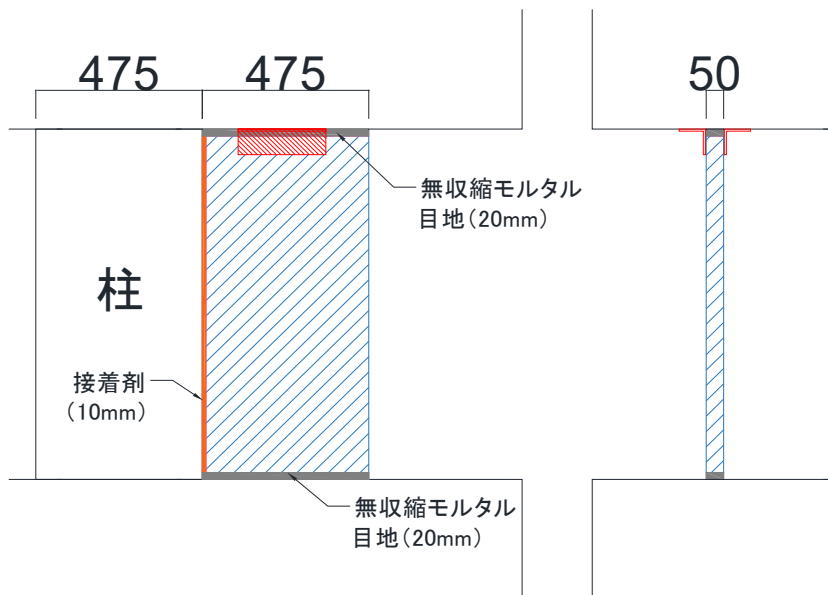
UFC 袖壁補強部分 立面図
